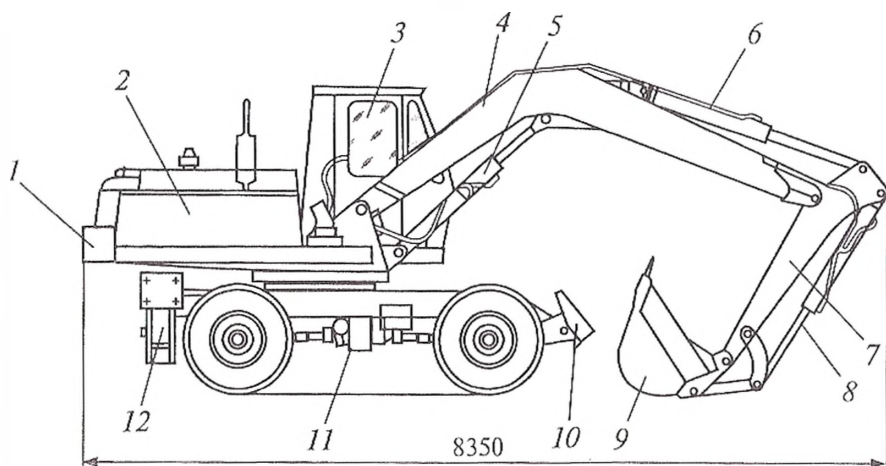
Одноковшовый полноповоротный экскаватор ЭО-3323А:
